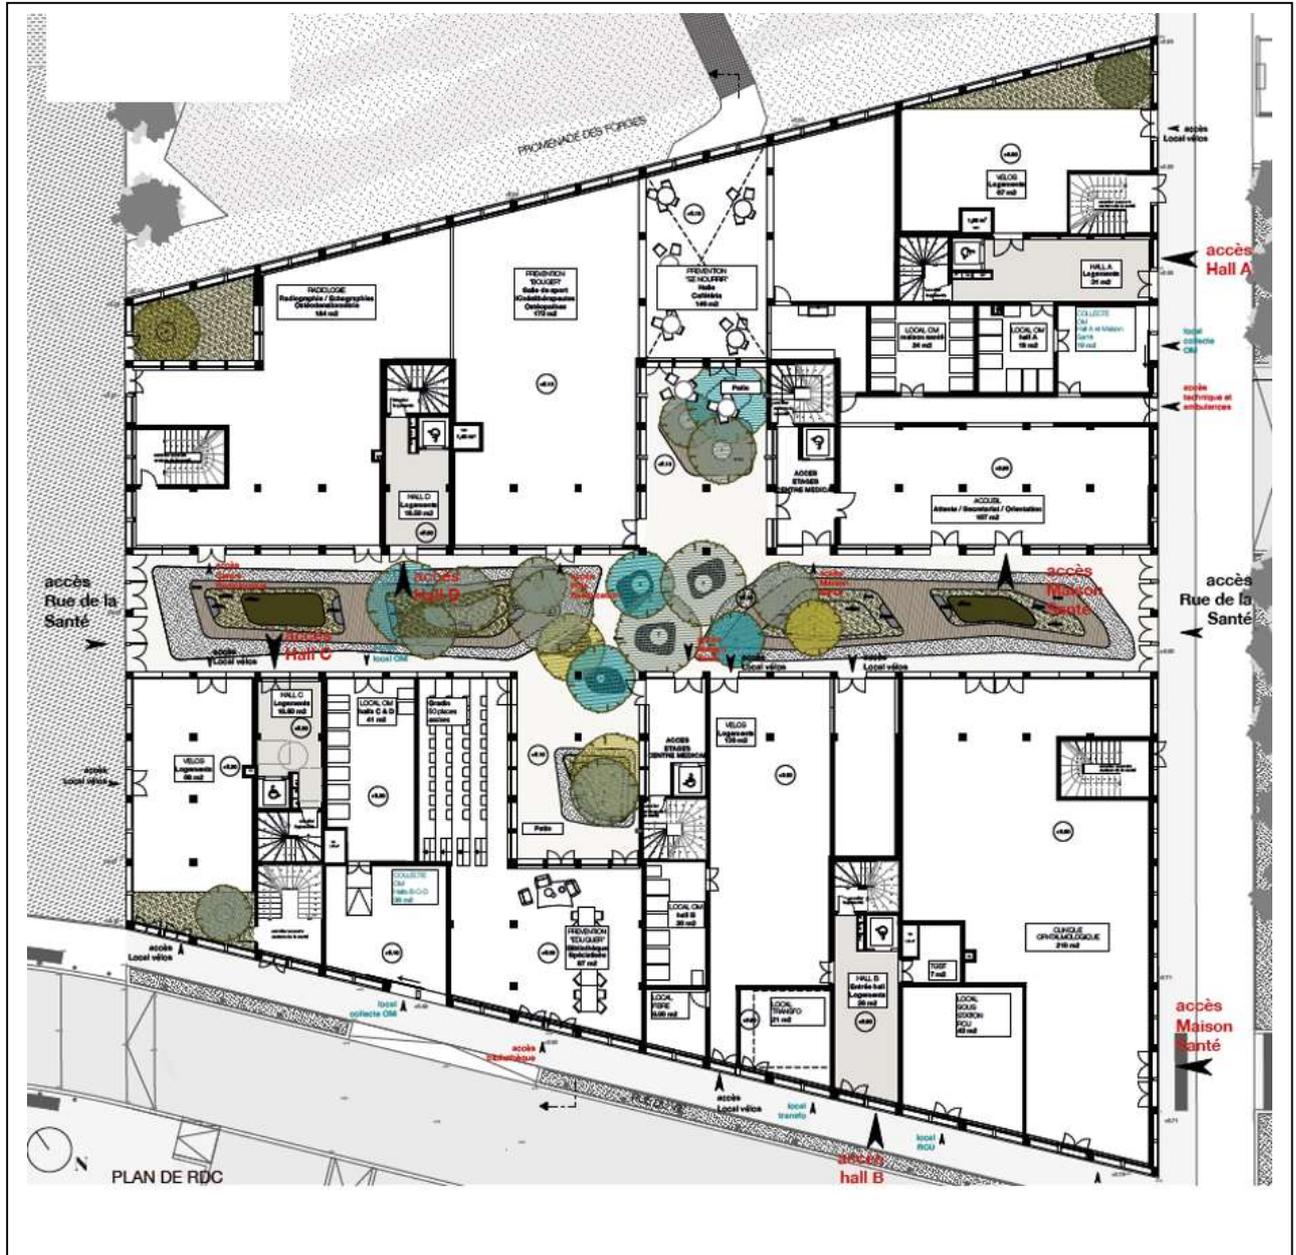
Plan de masse RDC du projet d'aménagement – Source : REALITES INGENIERIE
